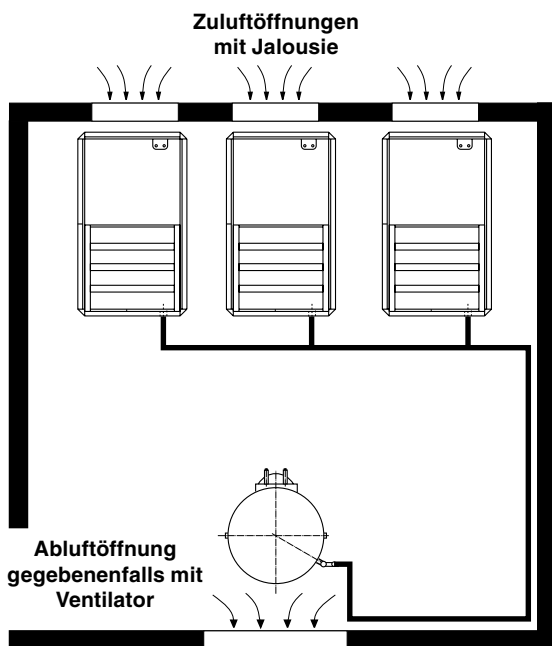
Betriebsraum mit drei schallgedämmten Kompressoren
